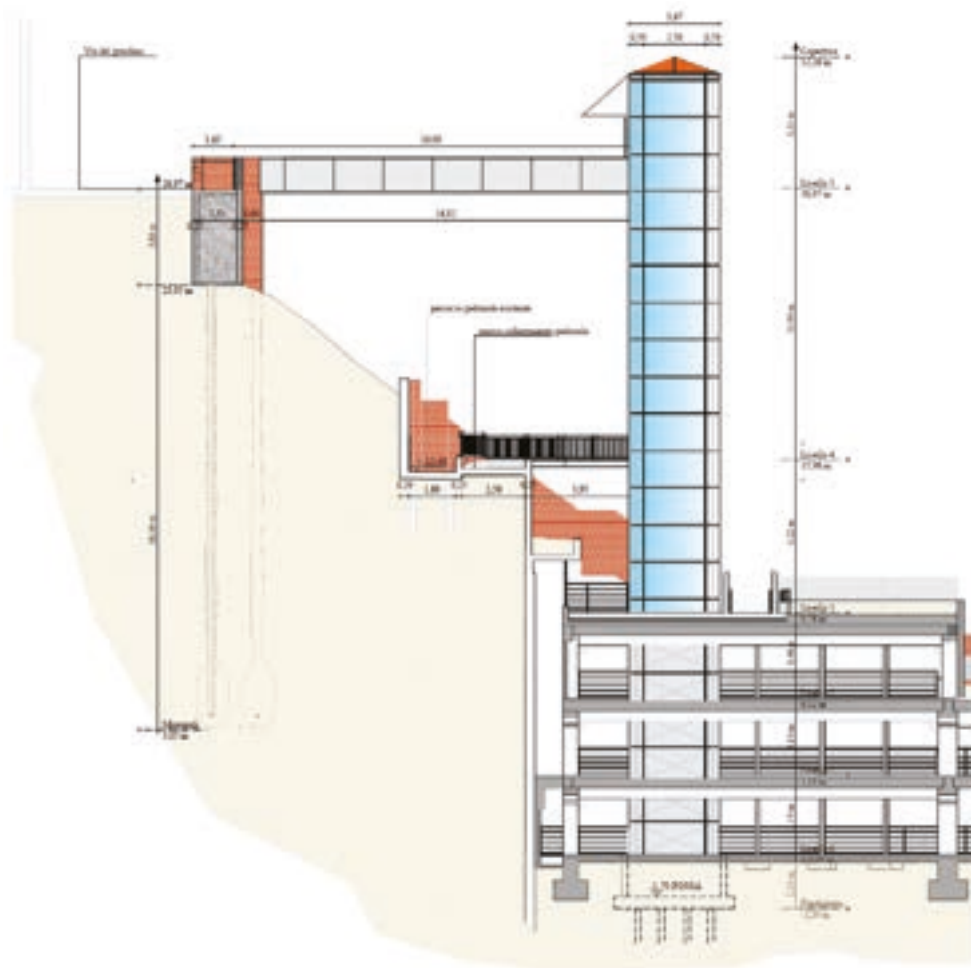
Sezione di progetto dell'intervento (prospetto nord).
